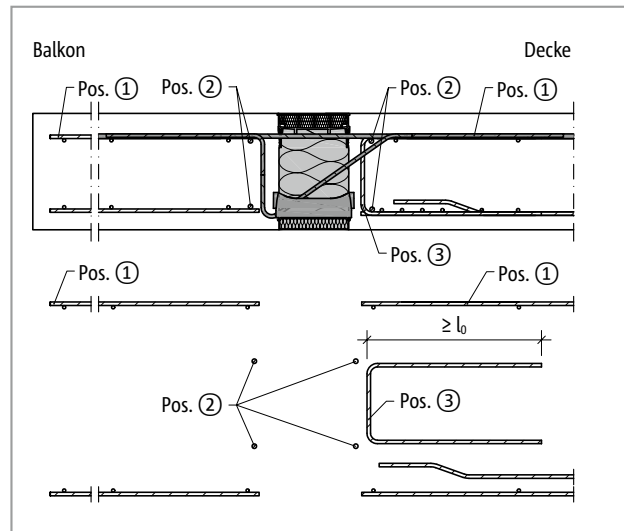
Schöck Isokorb® XT Typ K-M1 bis M10: Bauseitige Bewehrung bei indirekter Lagerung
